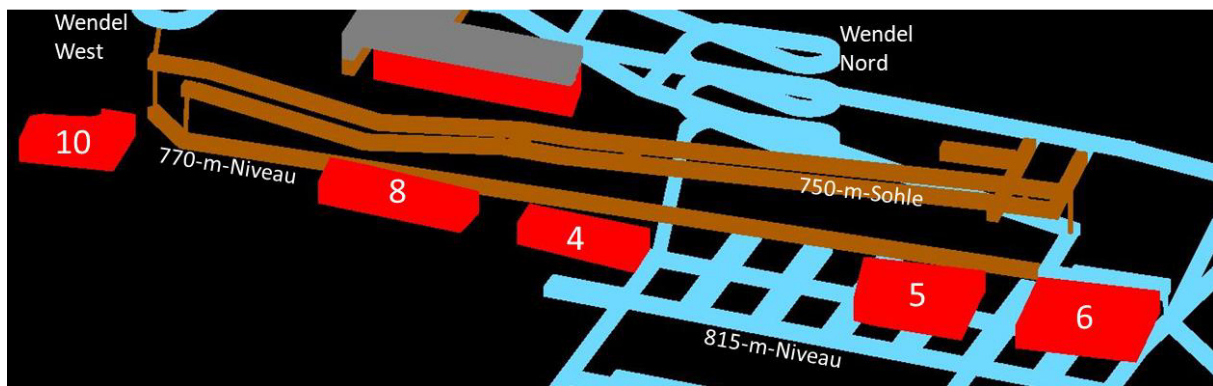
Skizze der Auffahrungen für Vorrichtung des Rückholbereiches Süd mit Transportstrecken und Schleusen auf 750-m-Sohle und rad. Abwetterstrecke auf 770-m-Niveau
